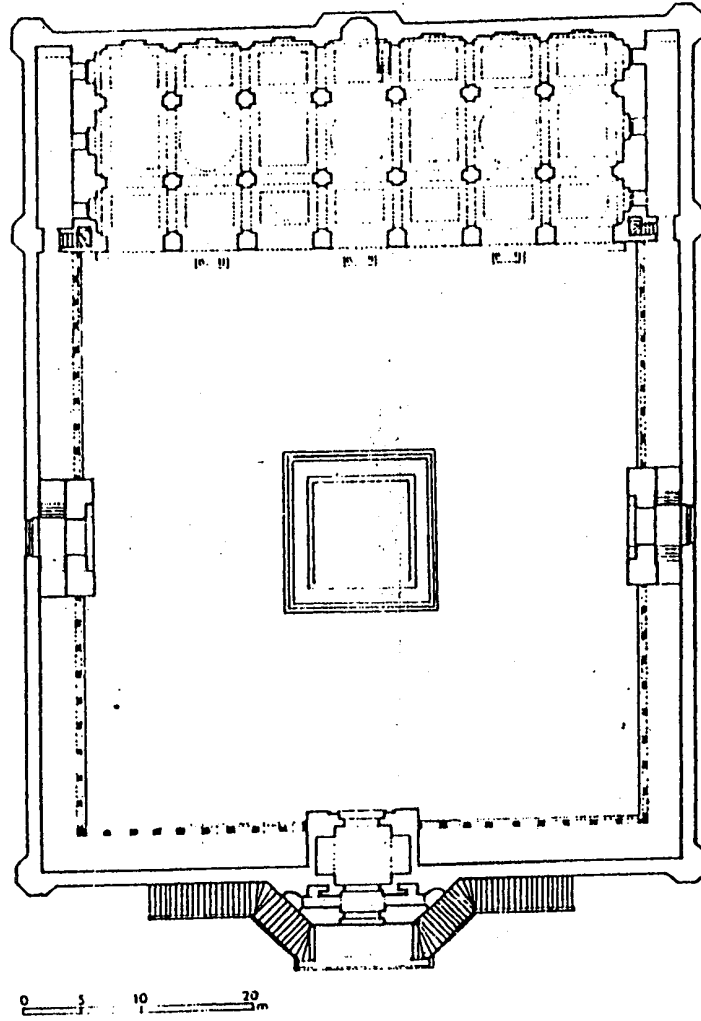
مسقط أفقي لجامع الصالح طلائع بالقاهرة
